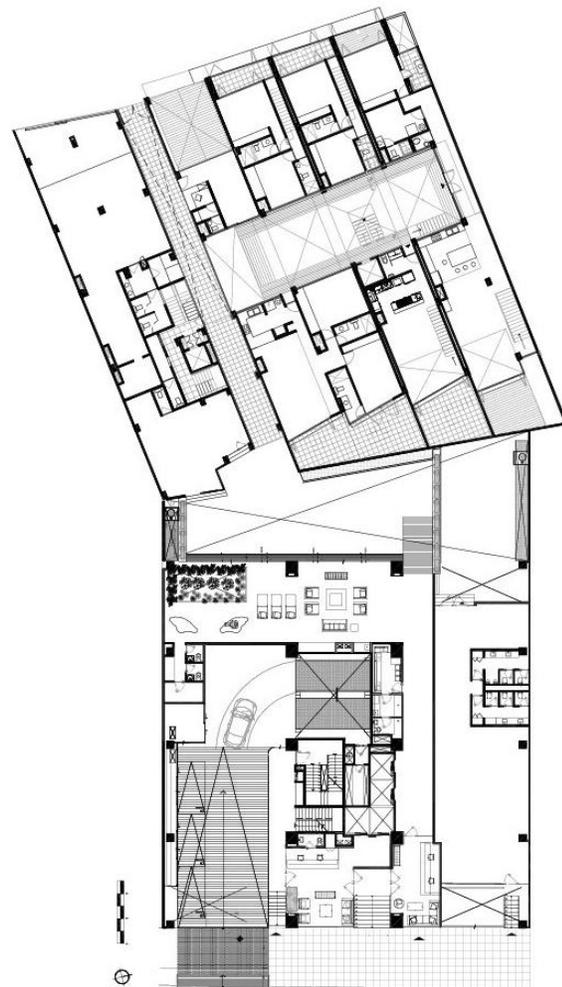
Vista de Planta Baja del edificio. Archidaily.com
